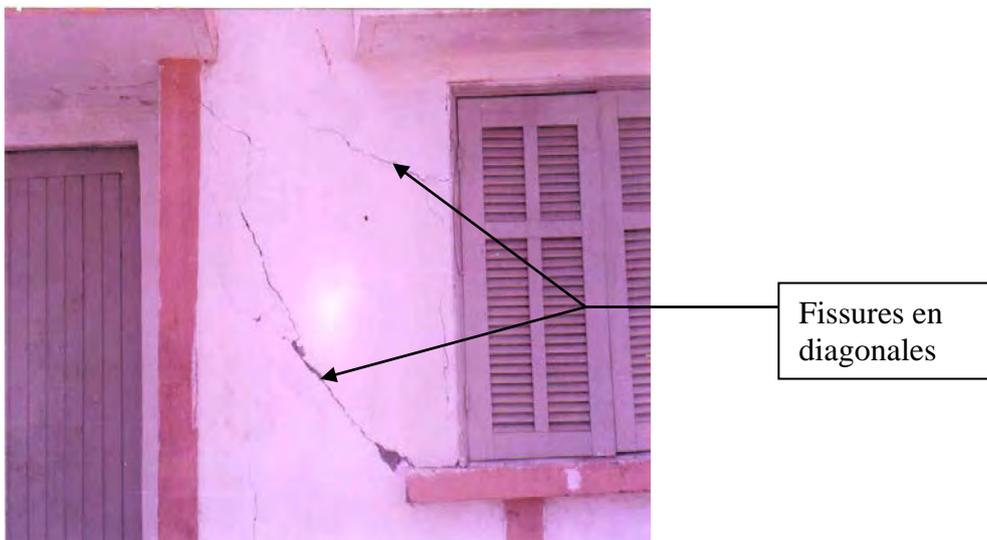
Fissuration d'une maison du village de Grand Mbao (image de la façade de la porte d'entrée).
